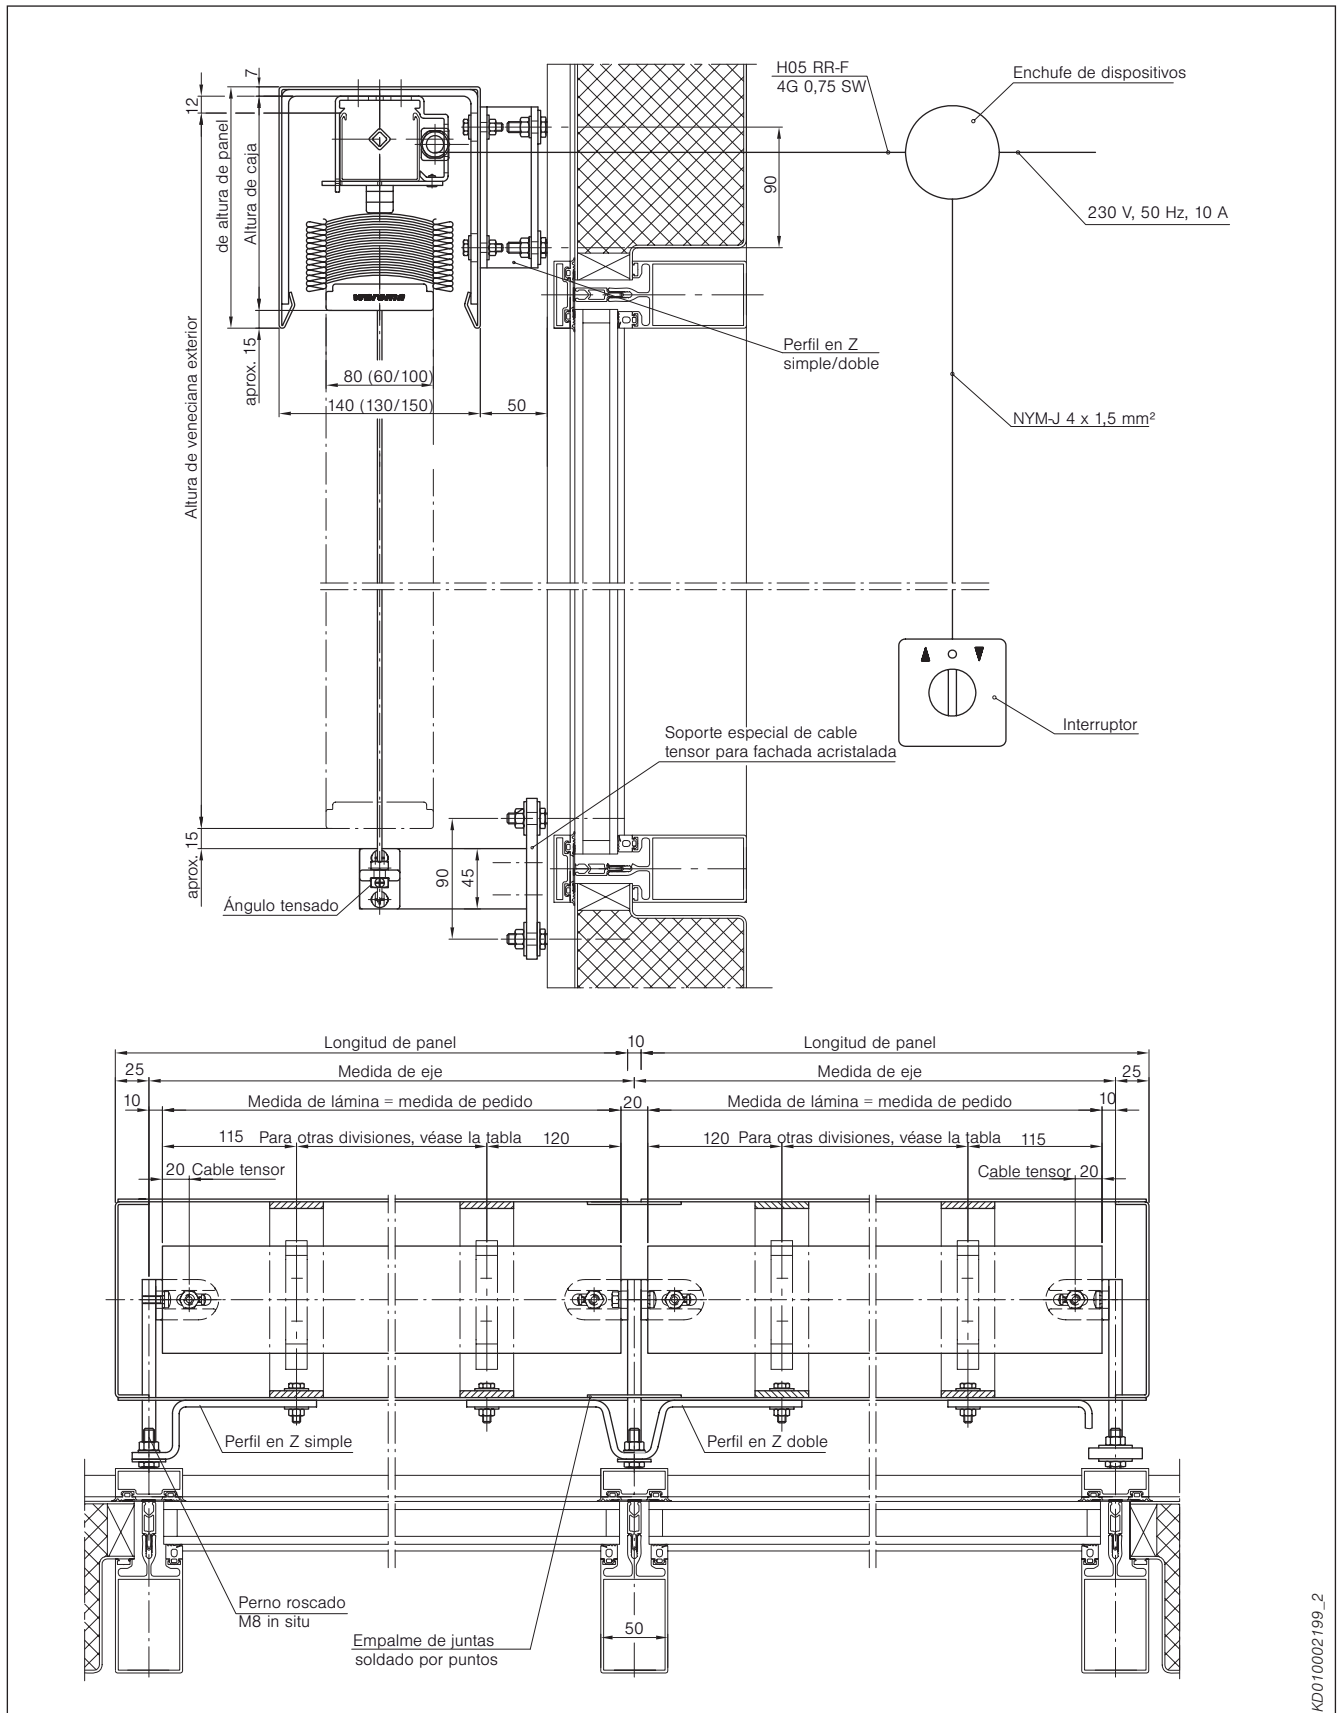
Ejemplo de montaje persianas venecianas exteriores tipos E 60/80/100 AF con láminas planas en un galería en "U" en una fachada acristalada
